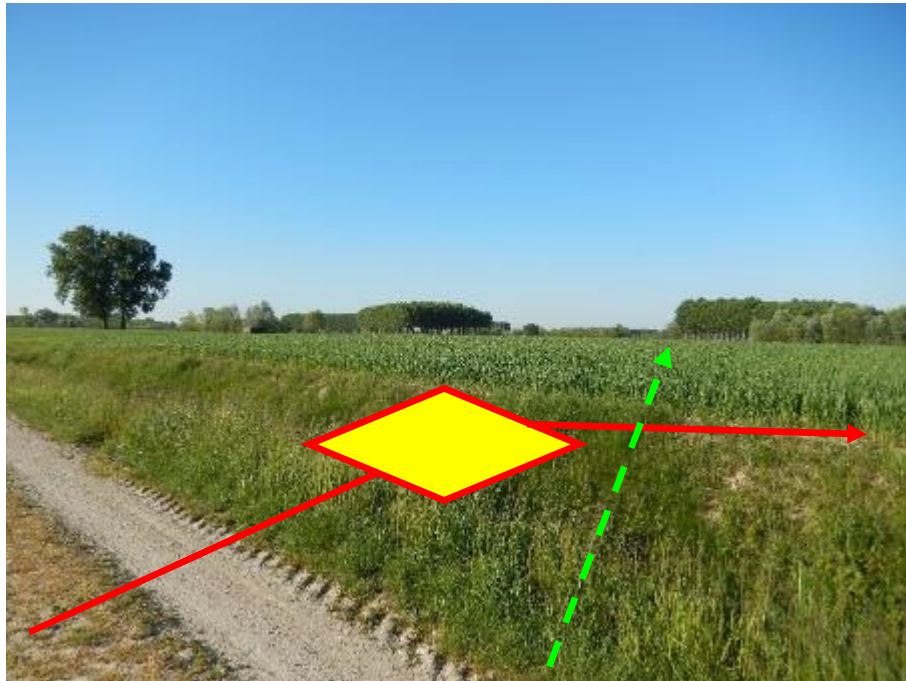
INSTALLAZIONE IMPIANTO PIDS 11B IN PROGETTO
